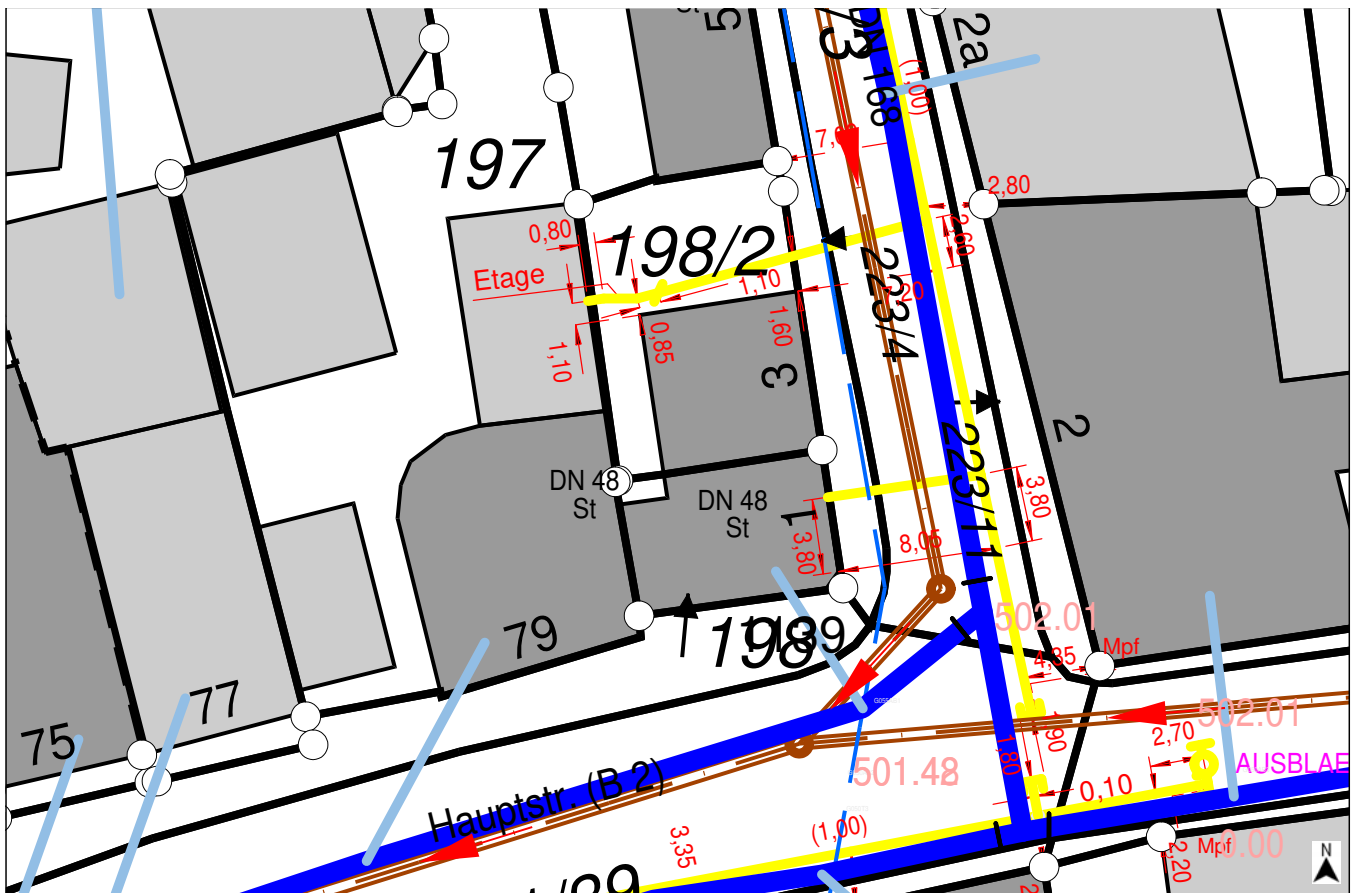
Hausanschlüsse der Hofer Straße 1+3
